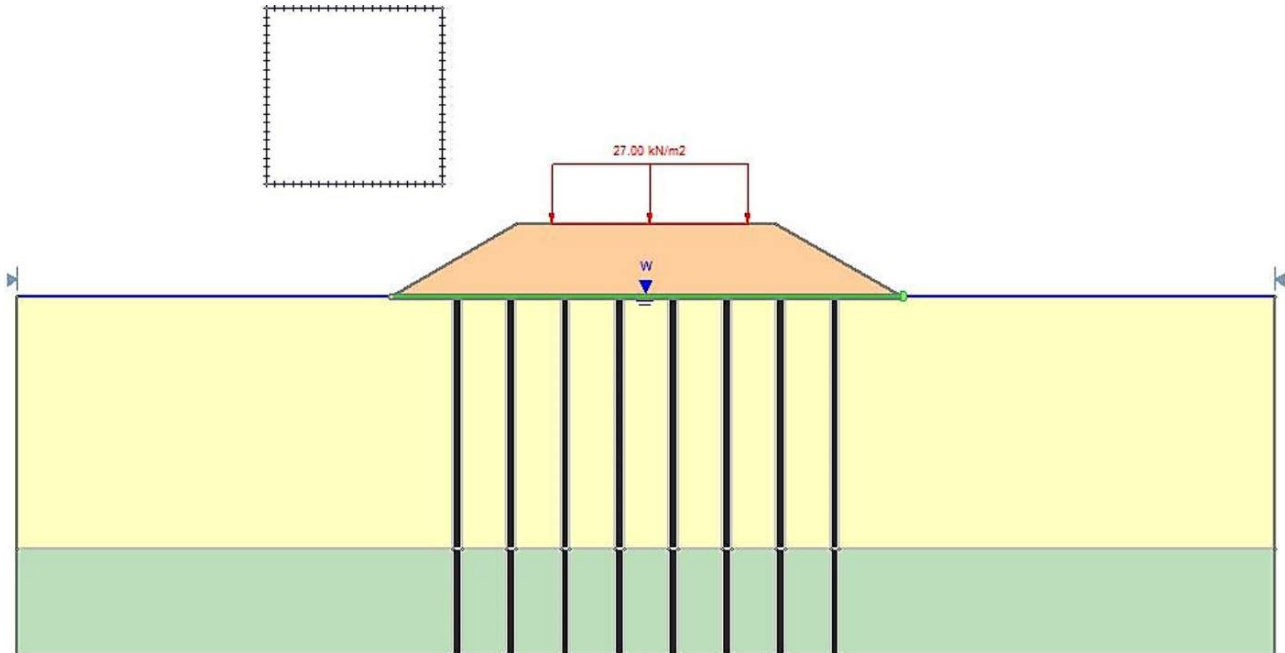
RILEVATO IN ZONA ARMELLINA – H = 4,0 M – SCHEMA DI CALCOLO
